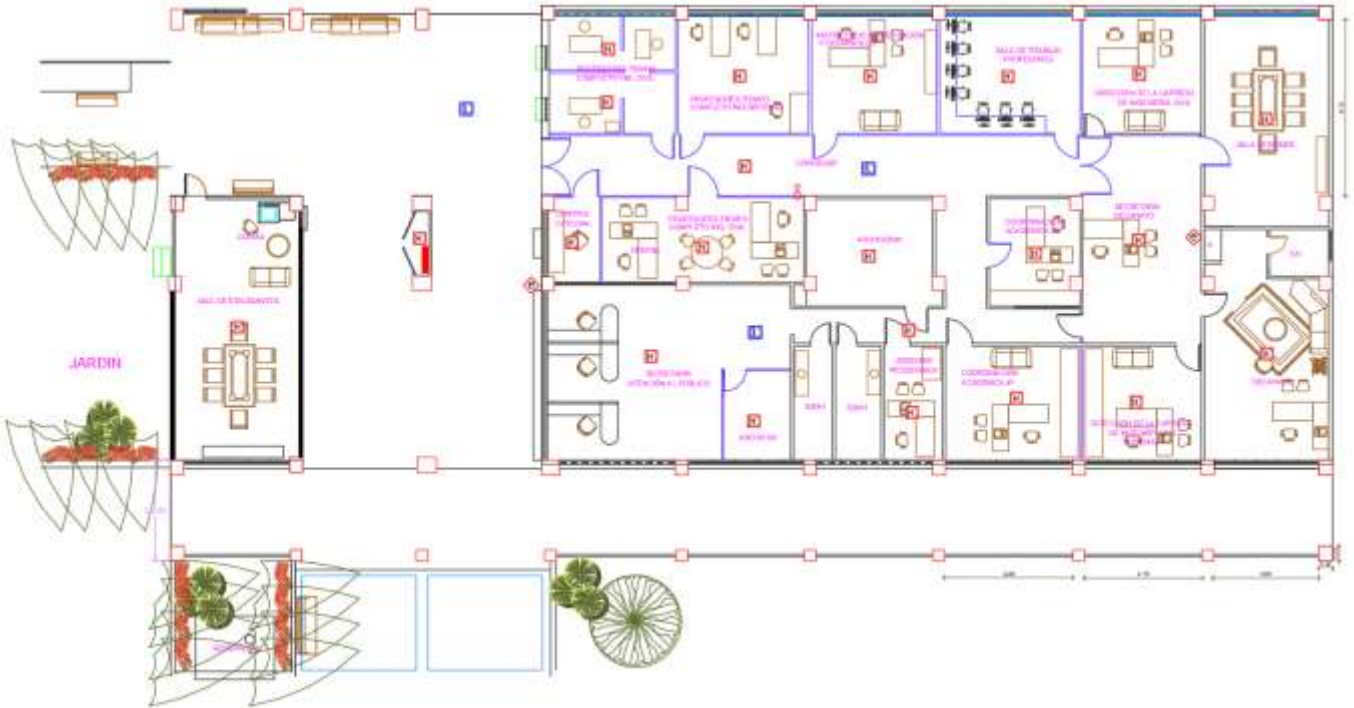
Planta baja - Plano arquitectónico. Fuente: (Coordinación Académica)
